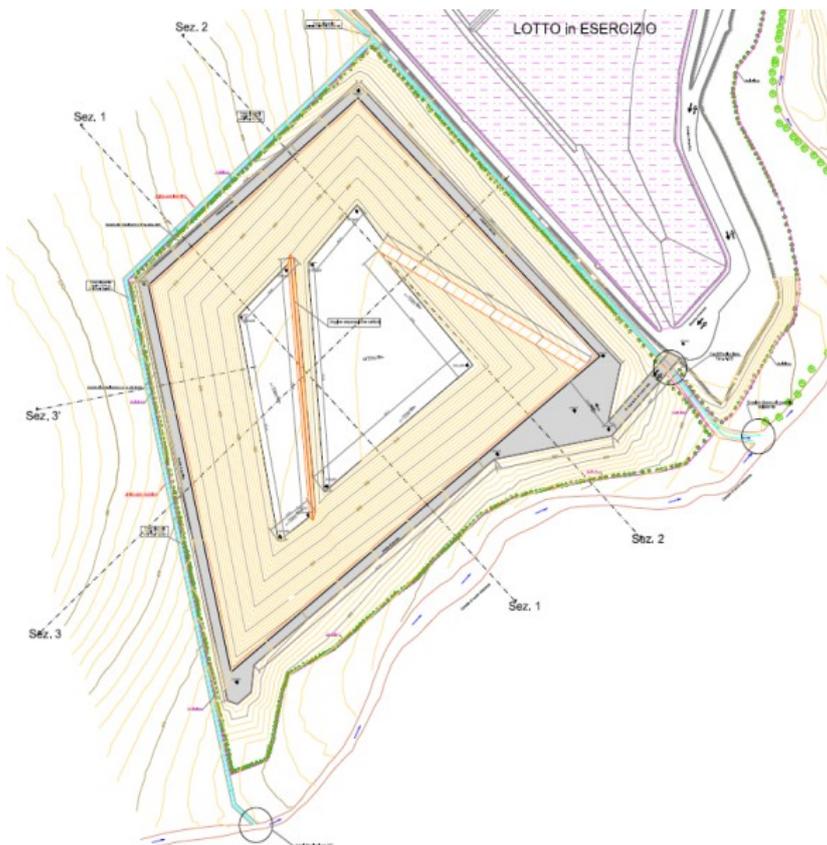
stralcio dalla TAV. 2.00 "Planimetria discarica lotto A"
